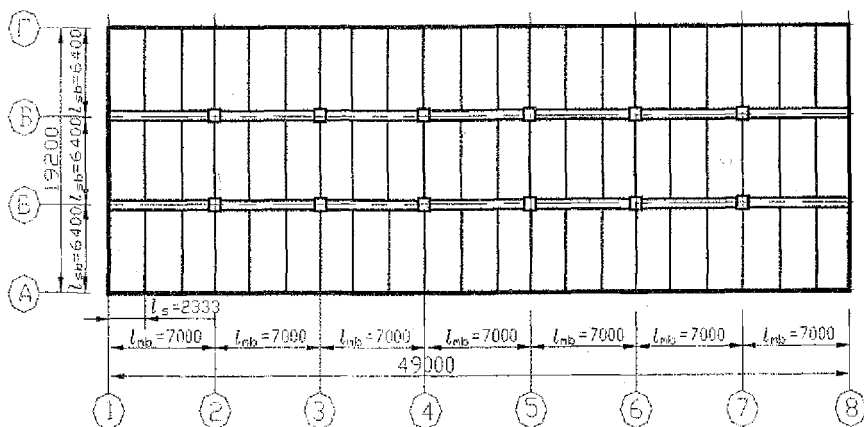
б — 2-ой вариант компоновки перекрытия
